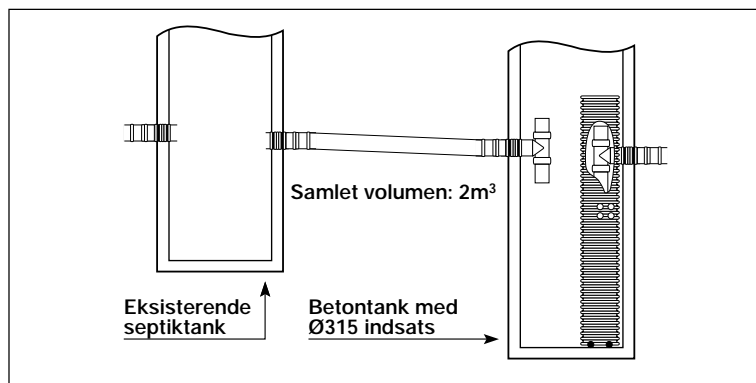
Bundfældningstank for enfamiliebolig udført i betonringe og Ø315 korrugeret indsatsrør. Indsatsen hæves et par cm over betonbunden og fastgøres ved hjælp af lidt beton, således at vandet ved tømning kan løbe ud i betonbrønden.
